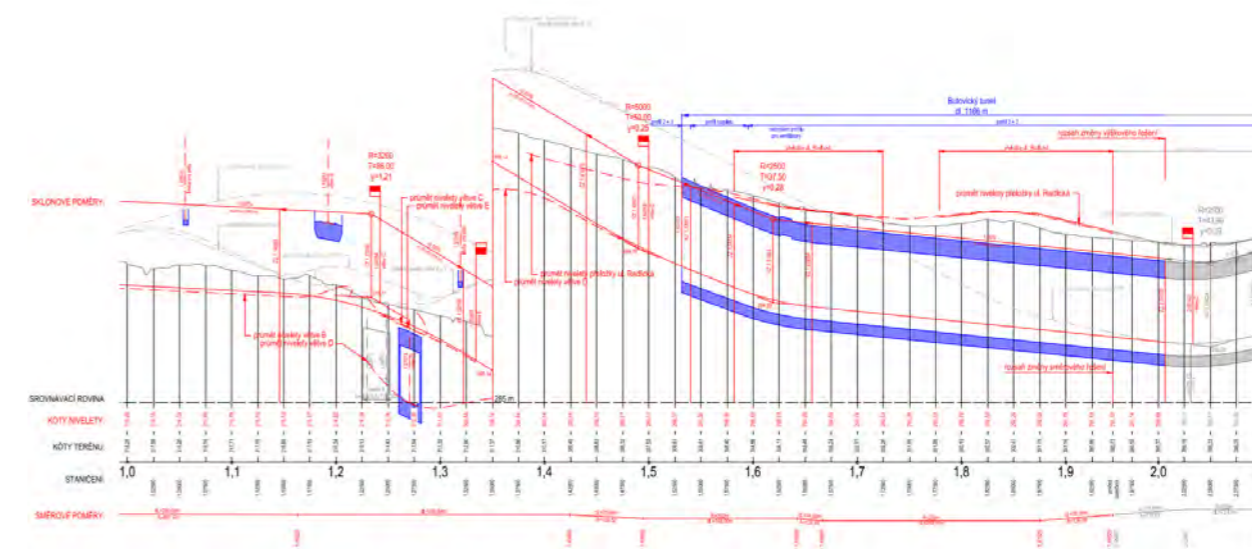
Úsek Botanica – podélný profil RR varianta B
